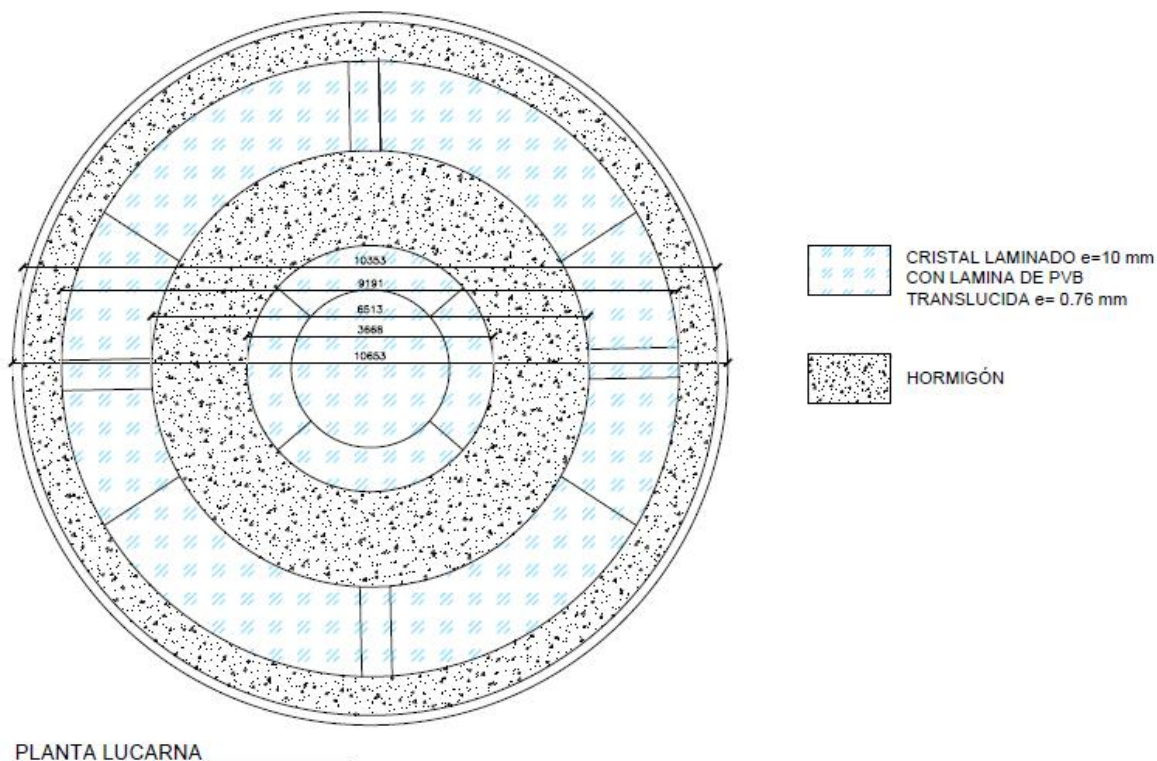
Zona de hormigón a impermeabilizar (Lucarna Tipología 2)
